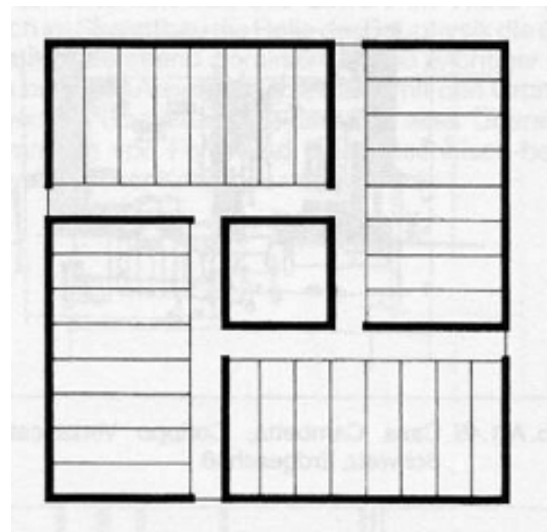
Grundrissprinzip Schachtel 1
